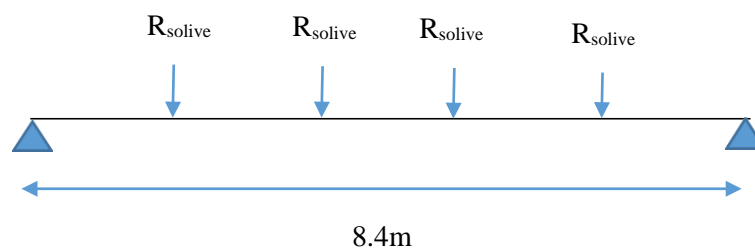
Schéma statique de poutre principale de plancher courant.
